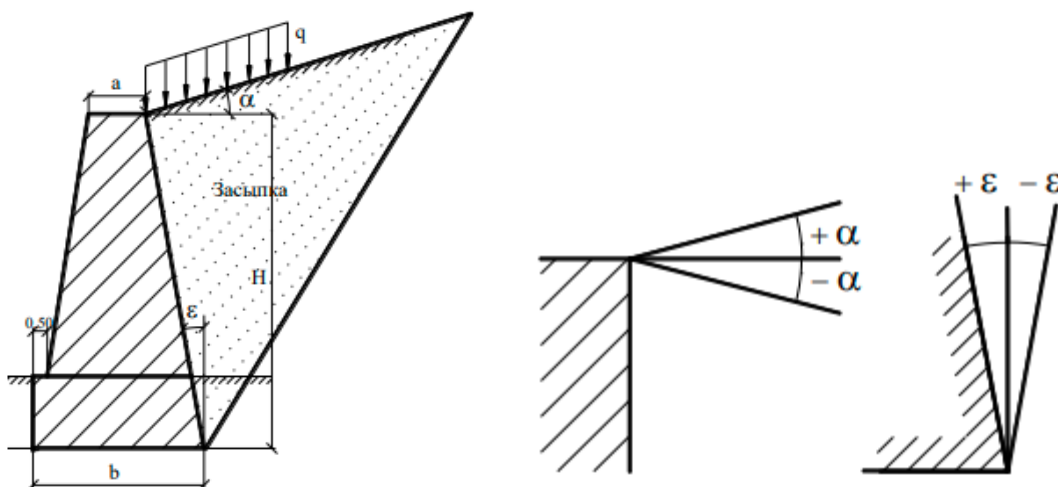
Расчетная схема к заданию на курсовое проектирование монолитной подпорной стены (схема к определению знака углов наклона стены)
